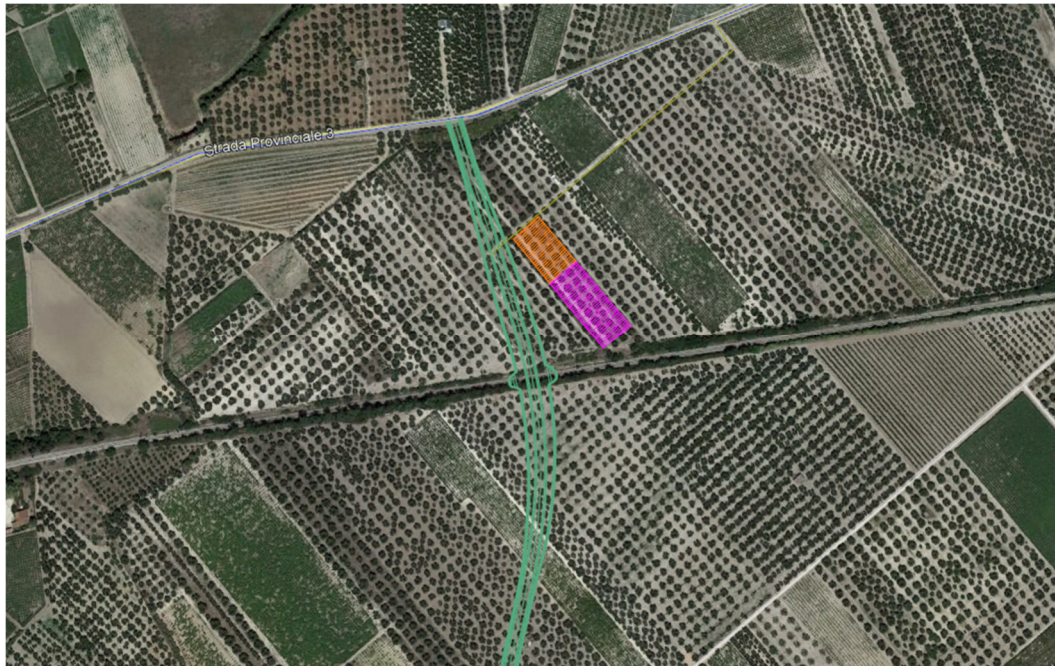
Vista dell'area di cantiere AT.07 (fonte Google Earth)
